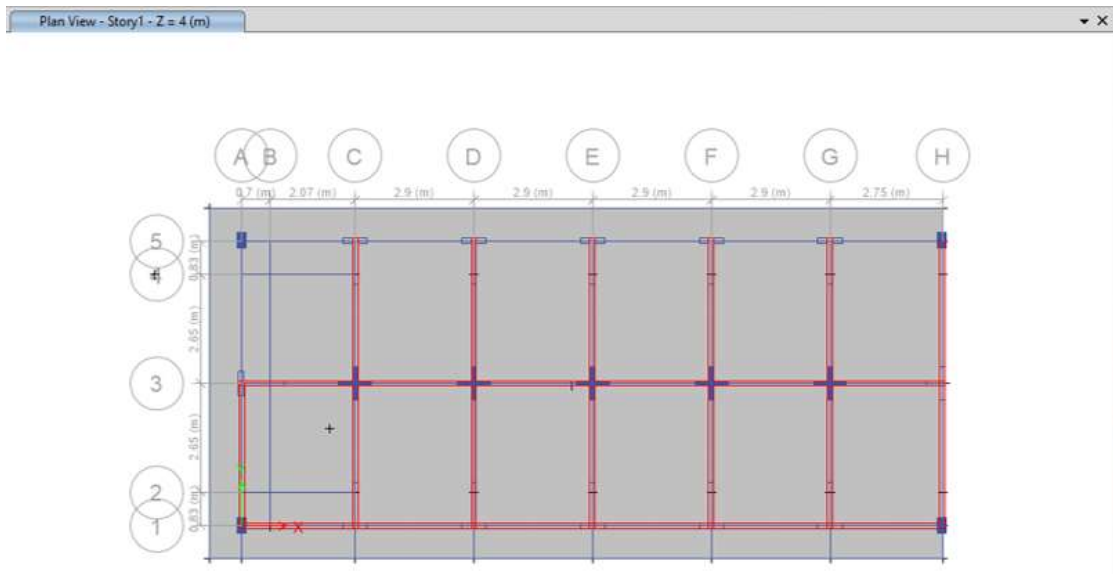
Se aprecia una vista de planta de la estructura modelada 1er nivel
